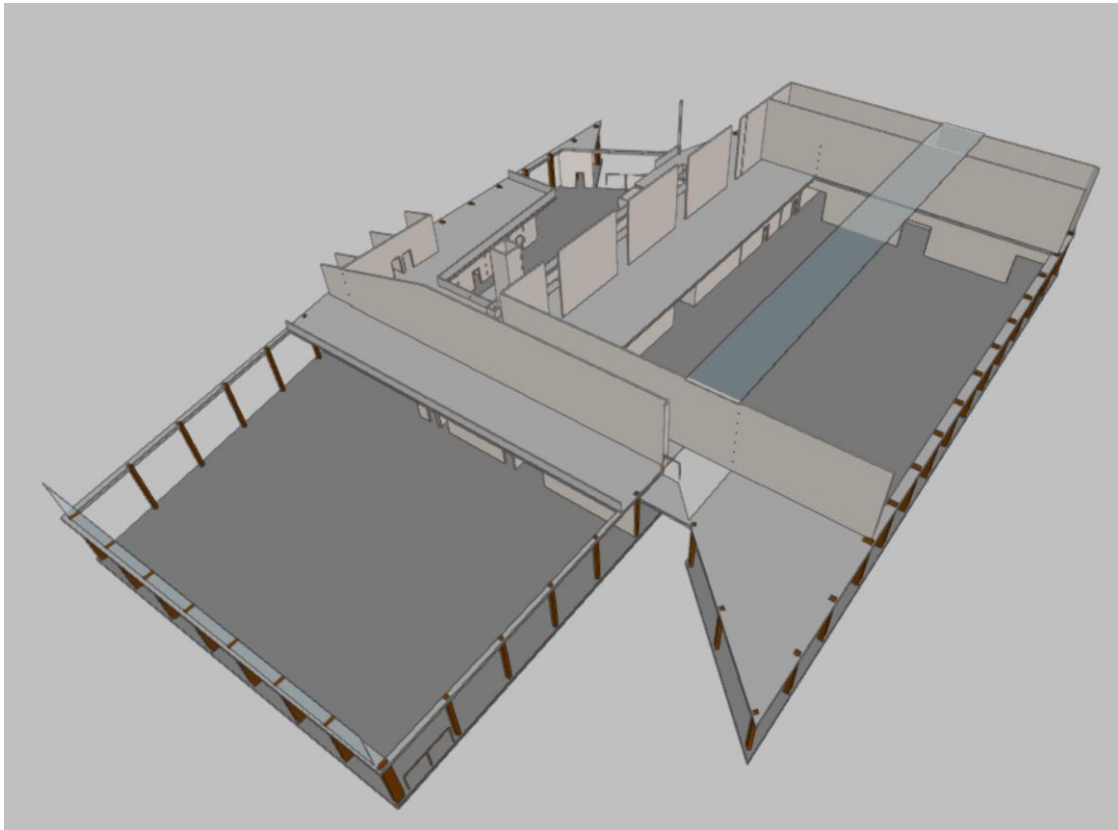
Vista 3D, interior del edificio, sin cubierta ni fachada
